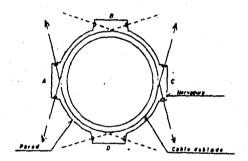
Detalle del cruzamiento de los cables sobre una nervadura de anclaje, en un elemento circular.
